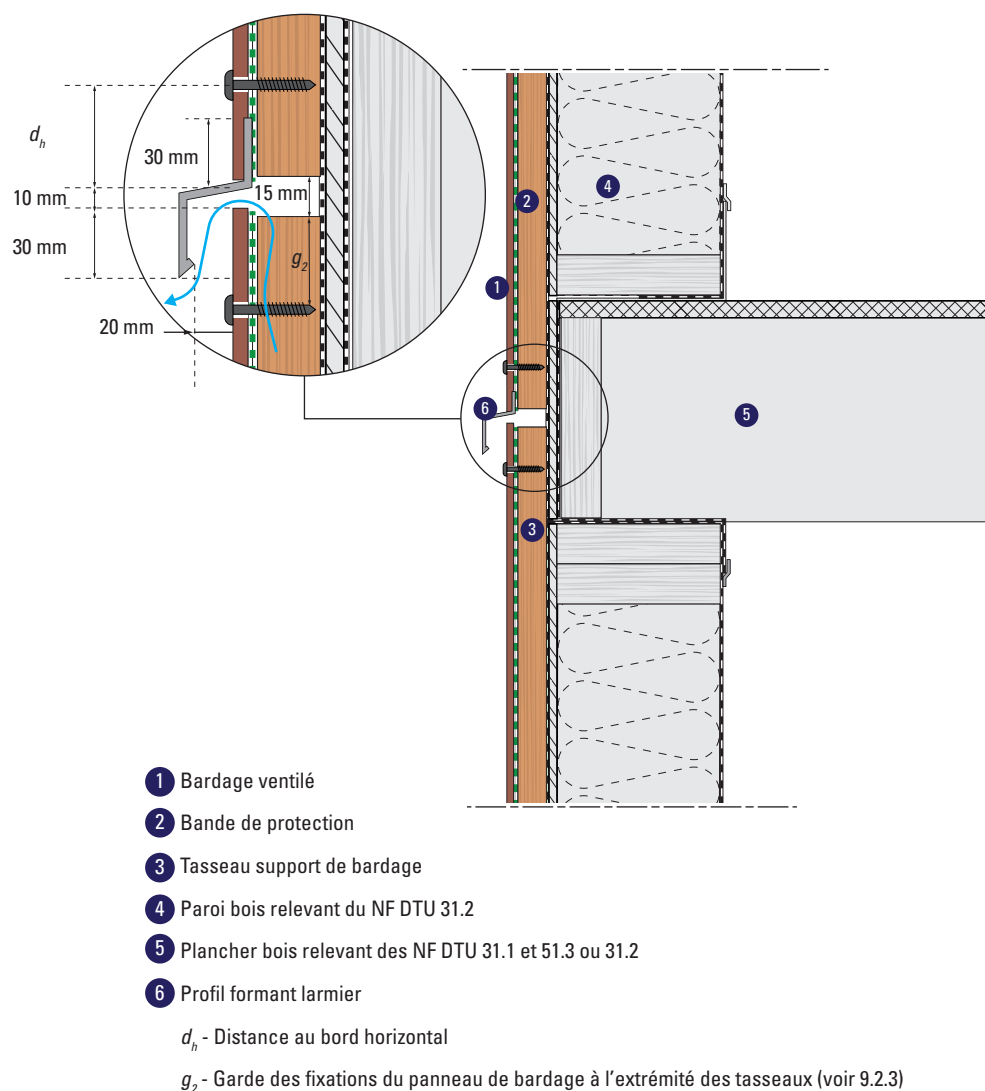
Exemple de fractionnement au droit d'un plancher bois (joints fermés) - coupe verticale
